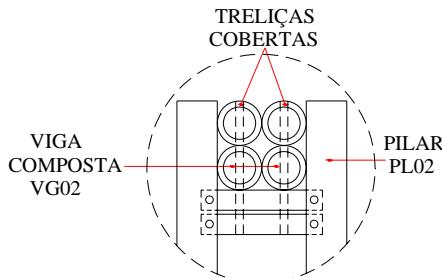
Concepção do pilar - Modelo PL02 (detalhe).
